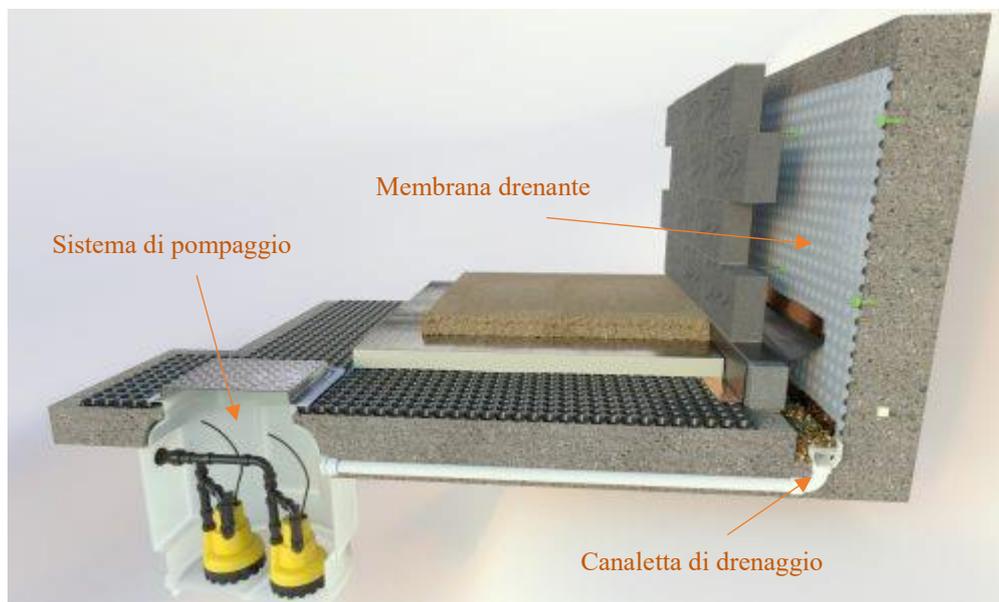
Sistema con cavità drenata (Fonte / <http://www.fisproducts.co.uk/our-solutions/structural-waterproofing/cavity-drain-systems/> [05/10/2017])
